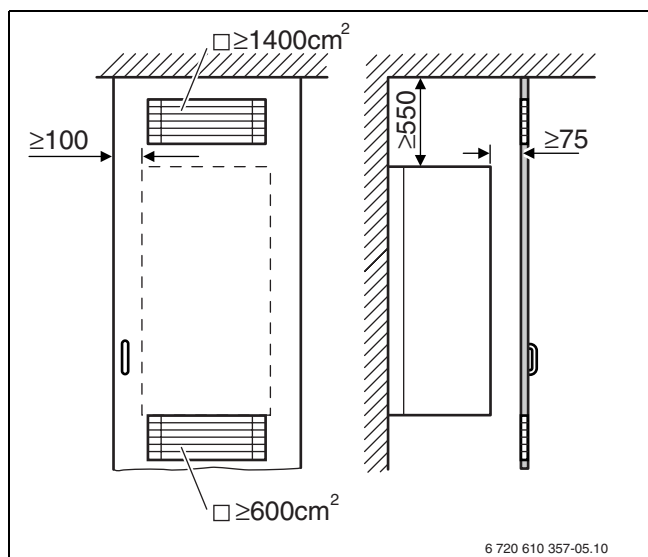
Griglie di aerazione obbligatorie, in caso d'installazione in armadietto copricaldaia
